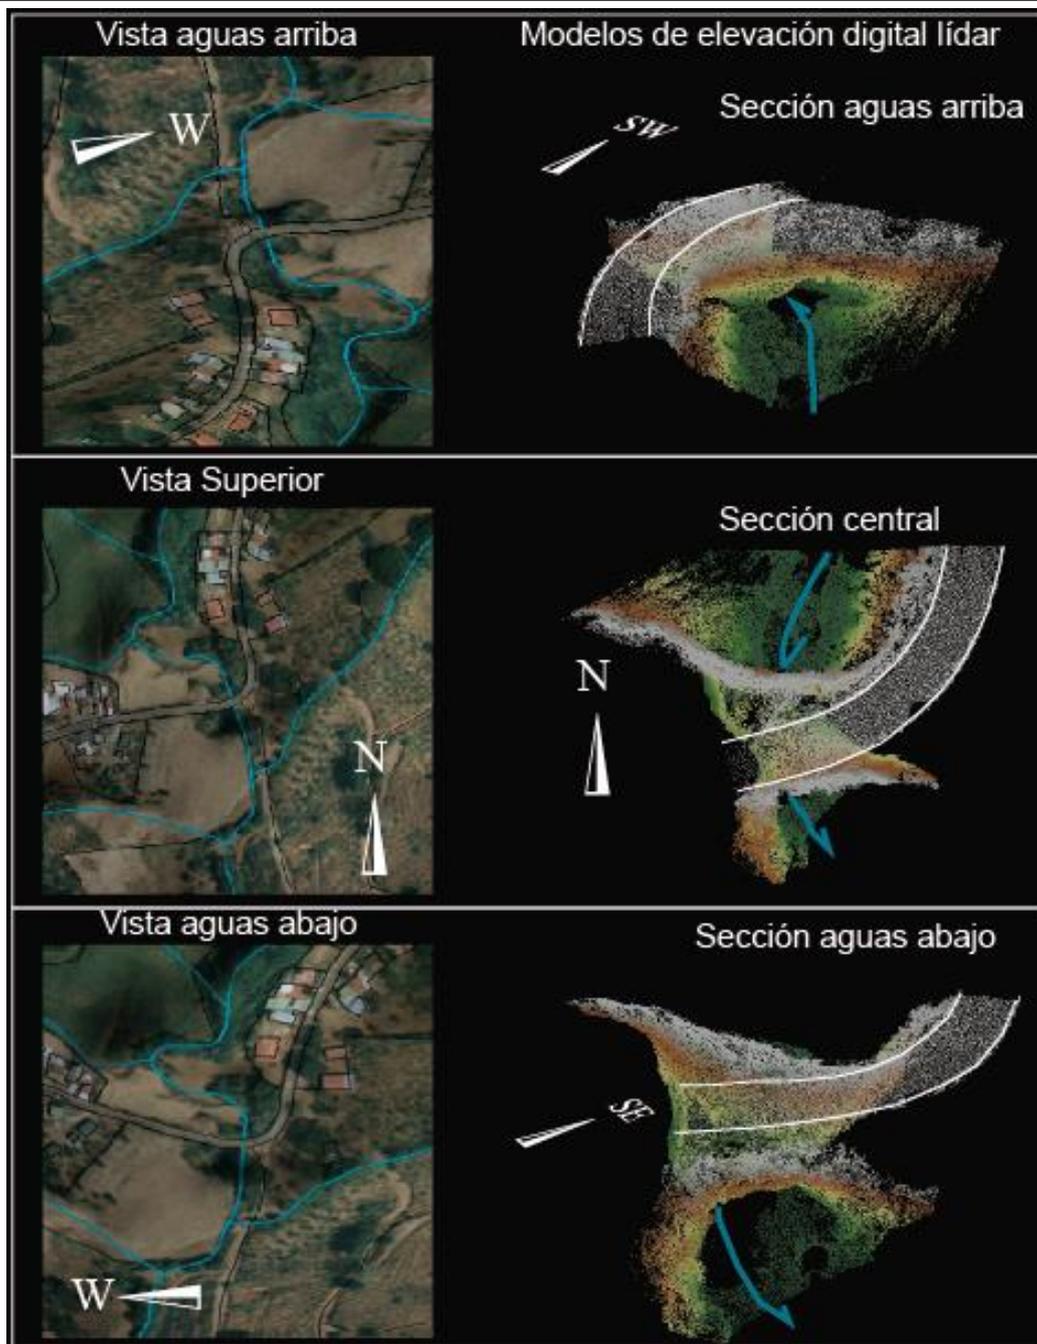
A la izquierda se muestran las diferentes vistas de la zona del puente en el modelo de elevación digital de la zona con una fotografía aérea. A la derecha se muestran las secciones del Puente de Piedra levantadas con el escáner Lídár y que fueron analizadas en detalle en este informe.
